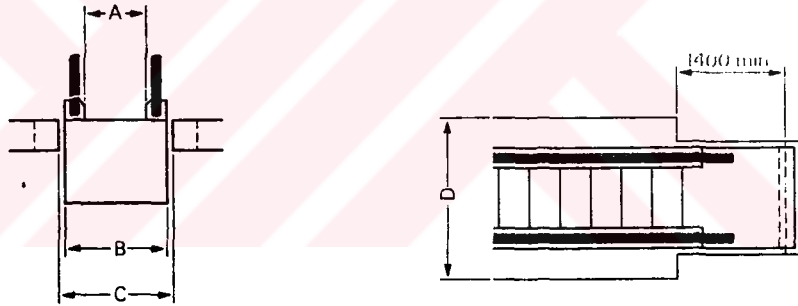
(38) 30 derece açılı yürüyen merdivenin planı
